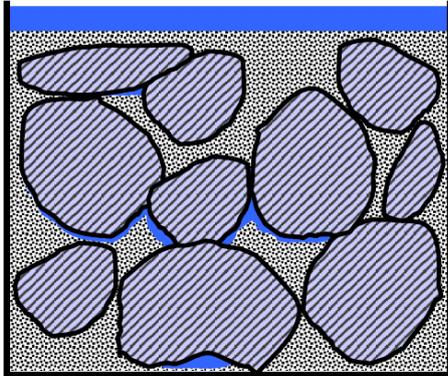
Schematische Darstellung des Wasserabsonderns im Beton [34]
